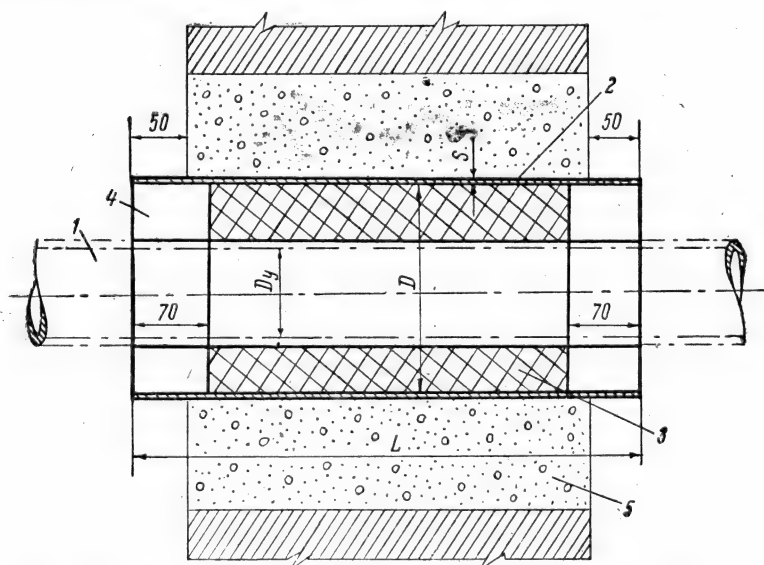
Футляр для прохода газопроводов через фундамент и стены:
